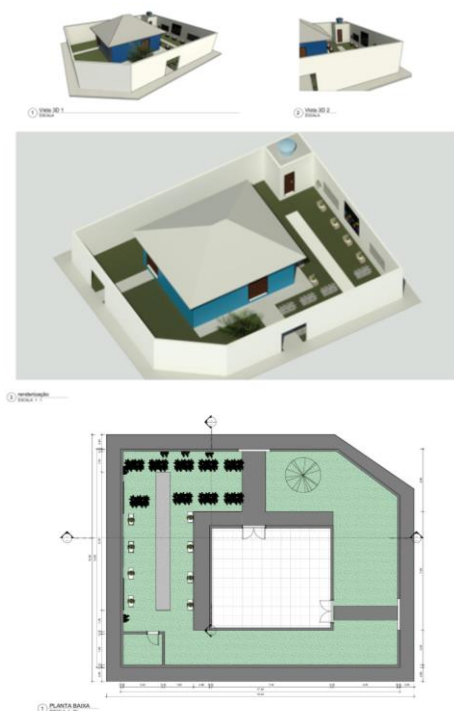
Planta baixa da área externa do CAPSi com planejamento da revitalização da horta.
